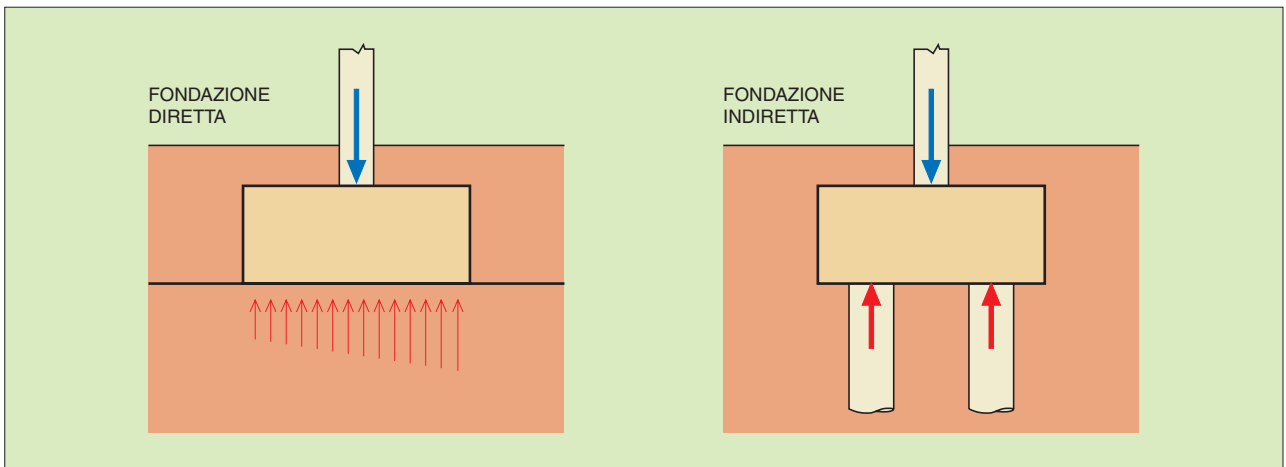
Il terreno trasmette carichi distribuiti alle fondazioni dirette e carichi concentrati in corrispondenza dei pali alle fondazioni indirette.
